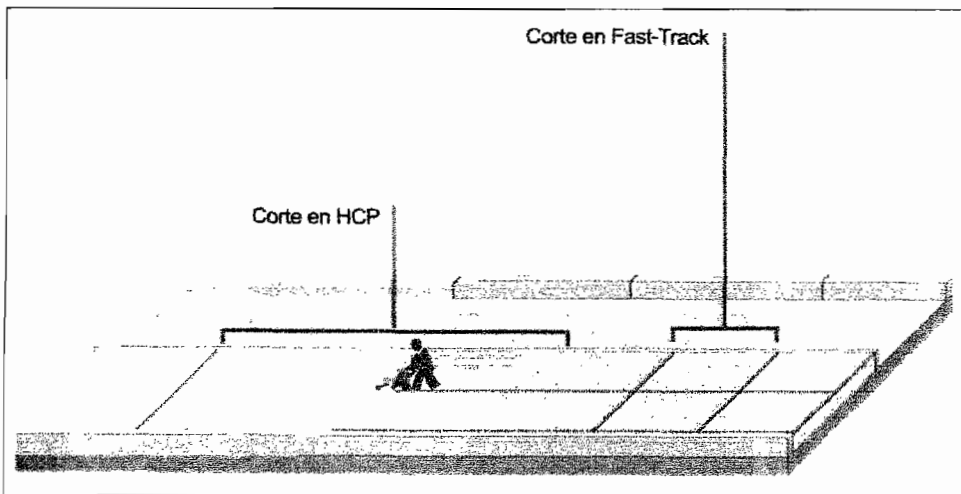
Corte de Juntas en la capa de Fast Track
